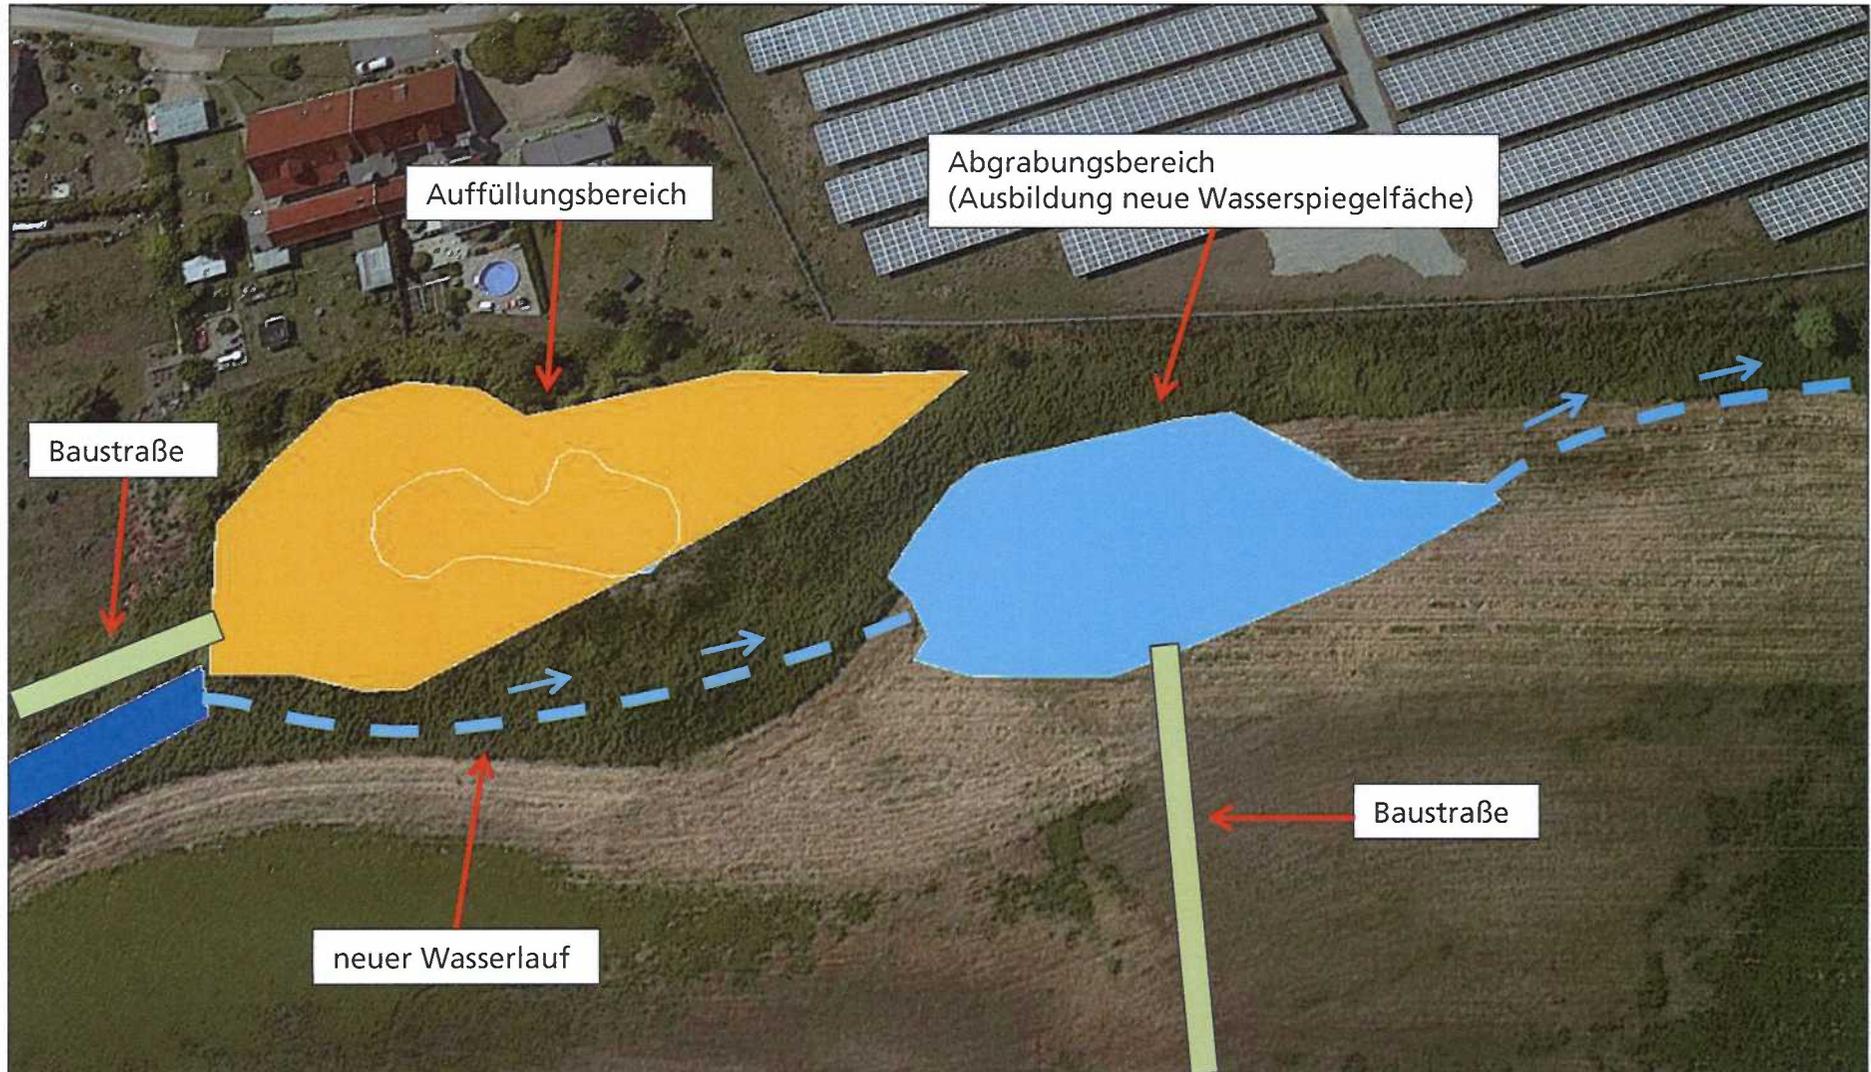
schematischer Lageplan der geplanten Profilierung
